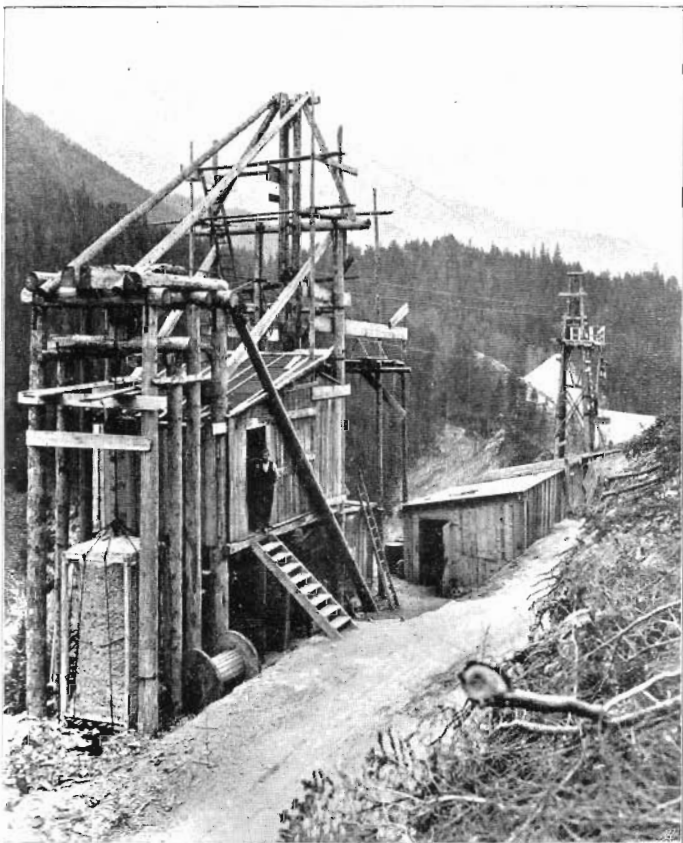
Antriebstation der Seil-Transportvorrichtung mit dem Spangewicht des Tragsseils.
